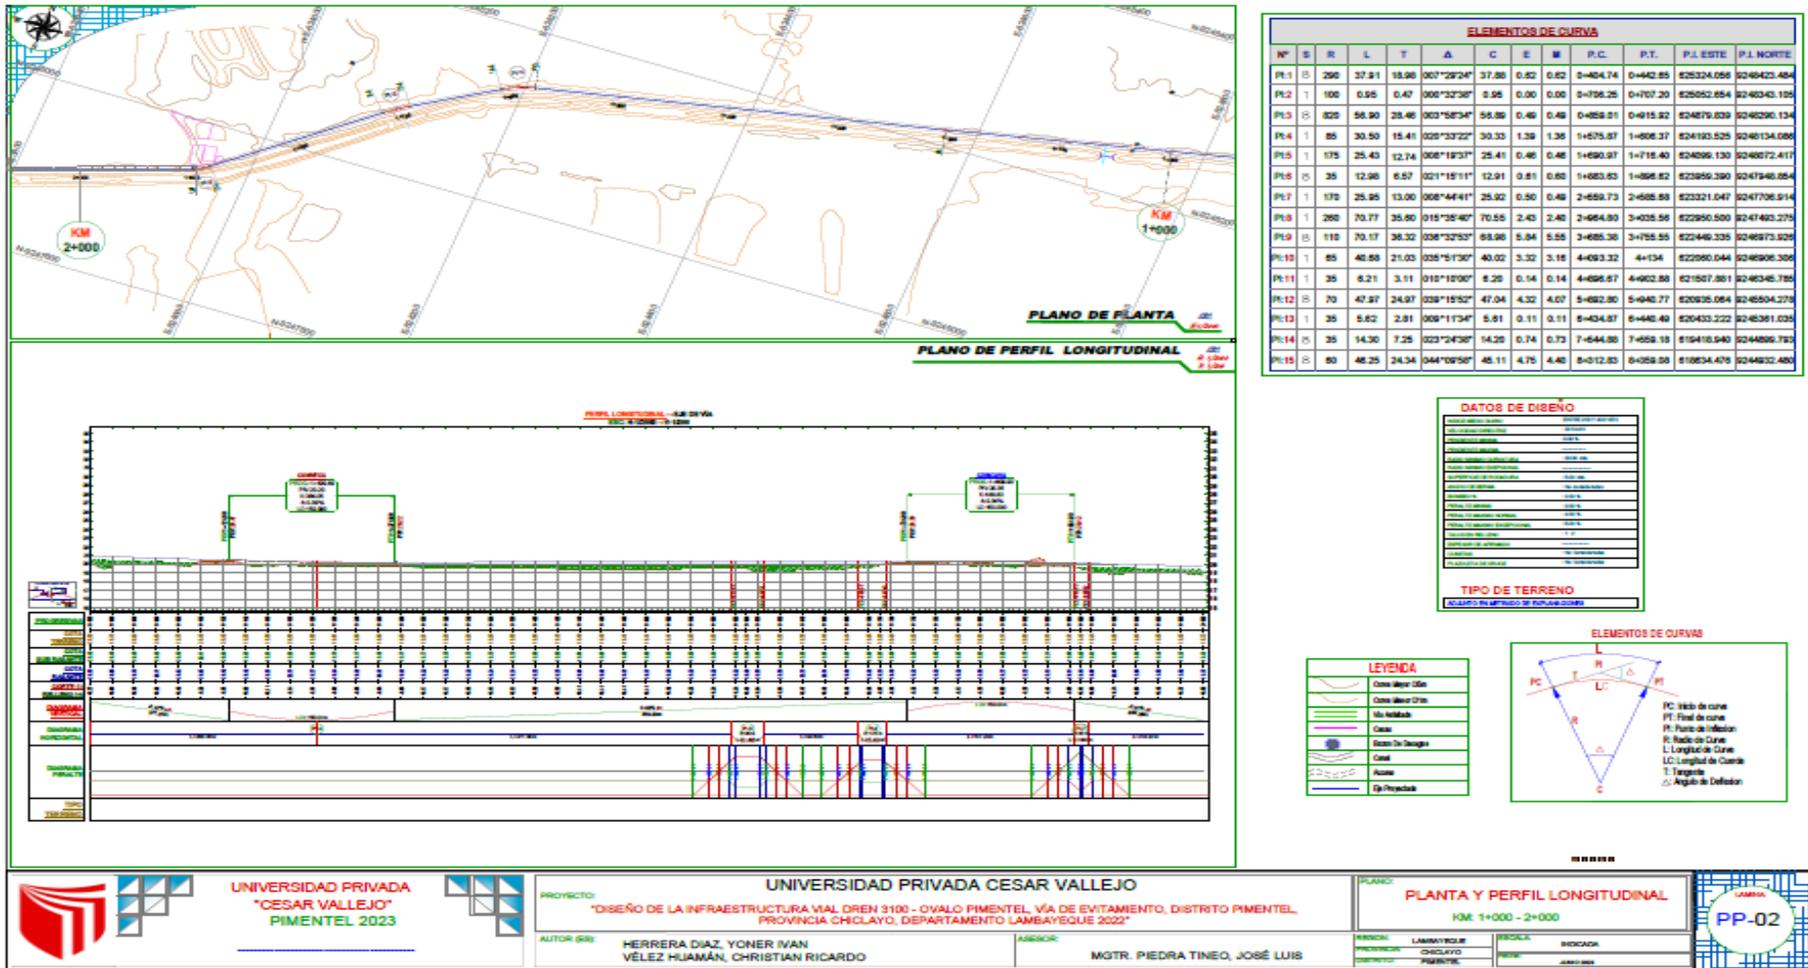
Planta y perfil longitudinal KM: 1+000 - 2+000
